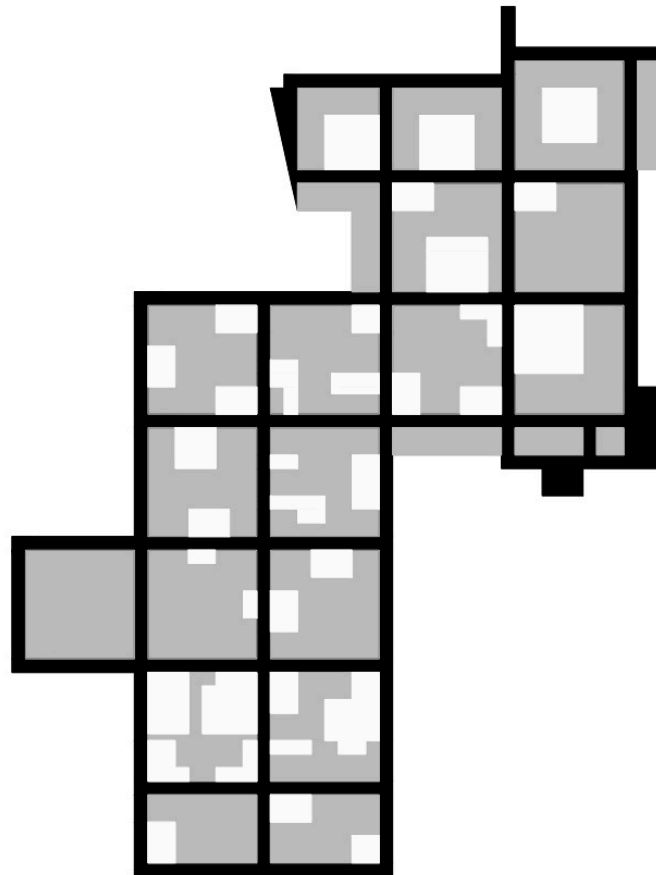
Planta da área de intervenção com a proposta, 1963
